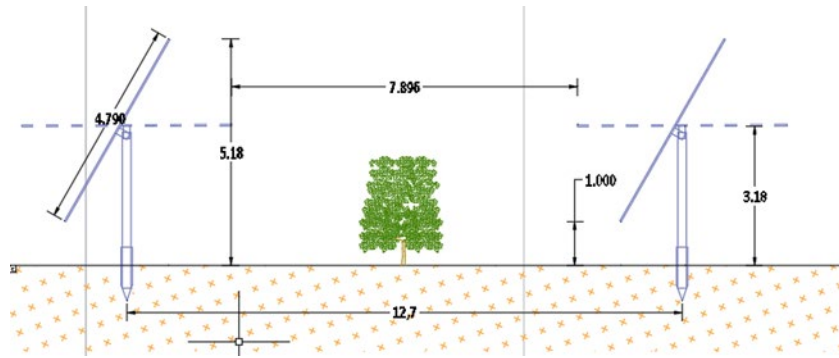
Sezione lotto d'impianto con tracker 2V30
